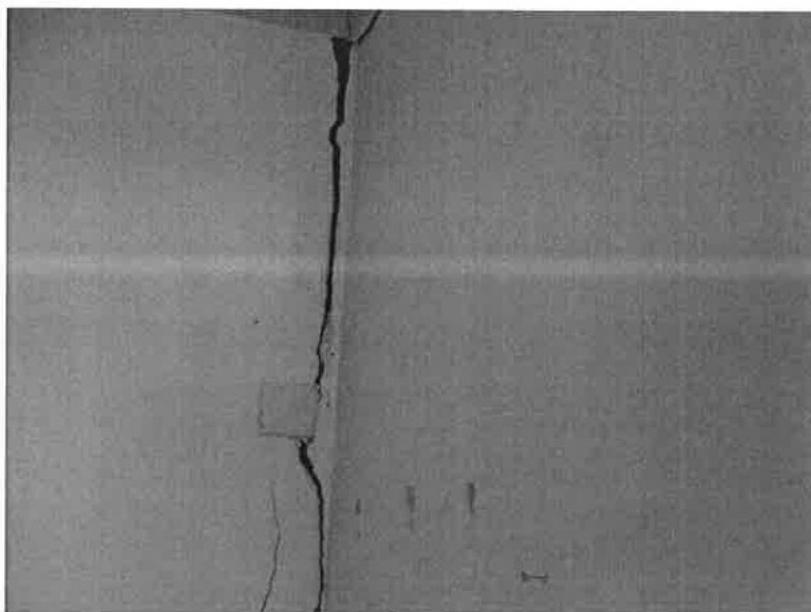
( Descolamento de parede interior da empena, 1º piso)
